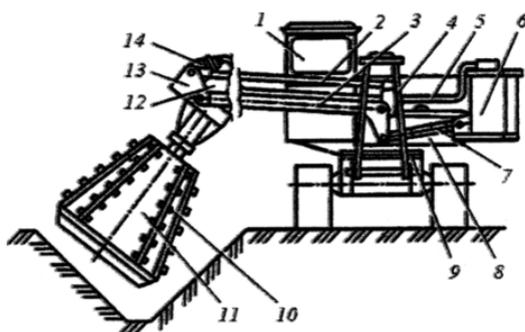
Лесной навесной каналоочиститель КЛН-1,2: 1 — трактор; 2 — верхняя тяга; 3 — нижняя тяга; 4 — опора; 5 — трубопровод гидросистемы; 6 — масляный бак; 7 — гидроцилиндр подъёма стрелы; 8 — поворотная колонна; 9 — платформа; 10 — тарельчатый нож; 11 фрезерный рабочий орган; 12 — редуктор; 13 — кронштейн; 14 — гидромотор
